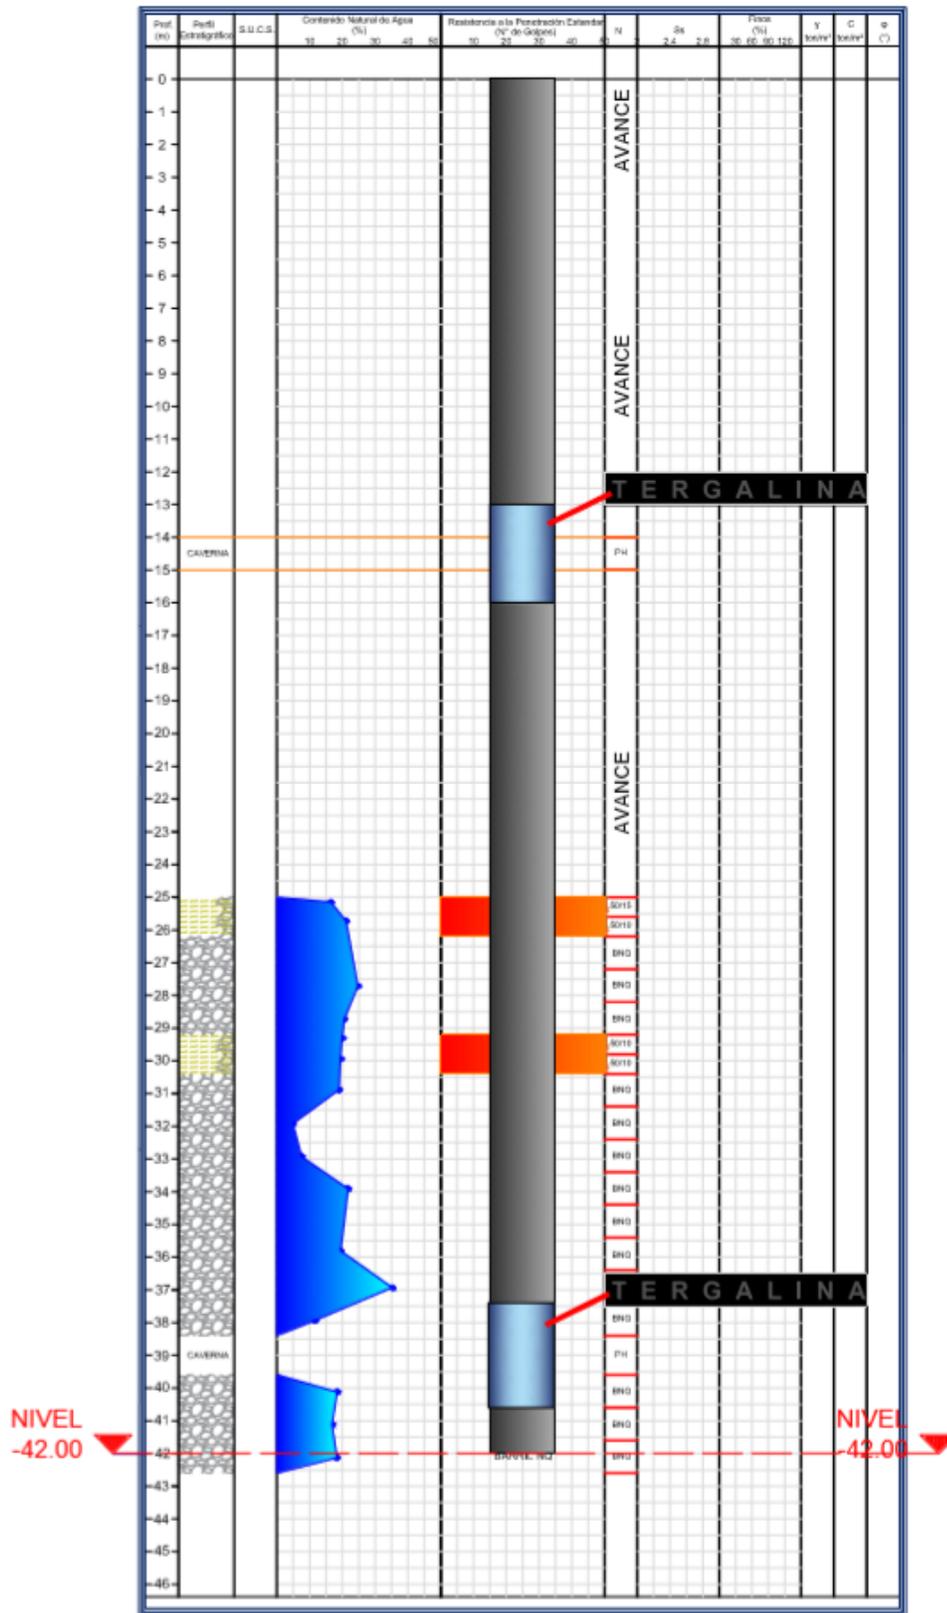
DESPLANTE DE PILA 24 (SM-16-EJE I1).
